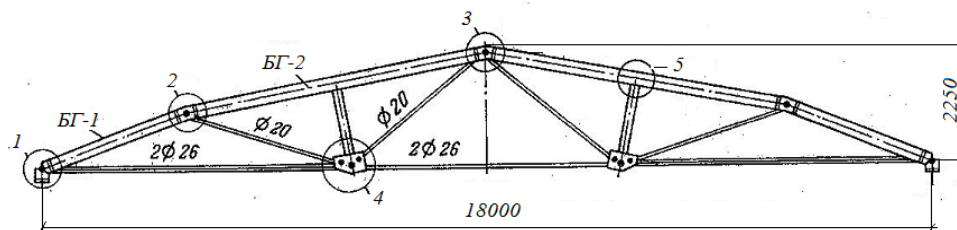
Пятиугольная ферма пролетом 18 м с брусчатым верхним поясом (тип-4)
